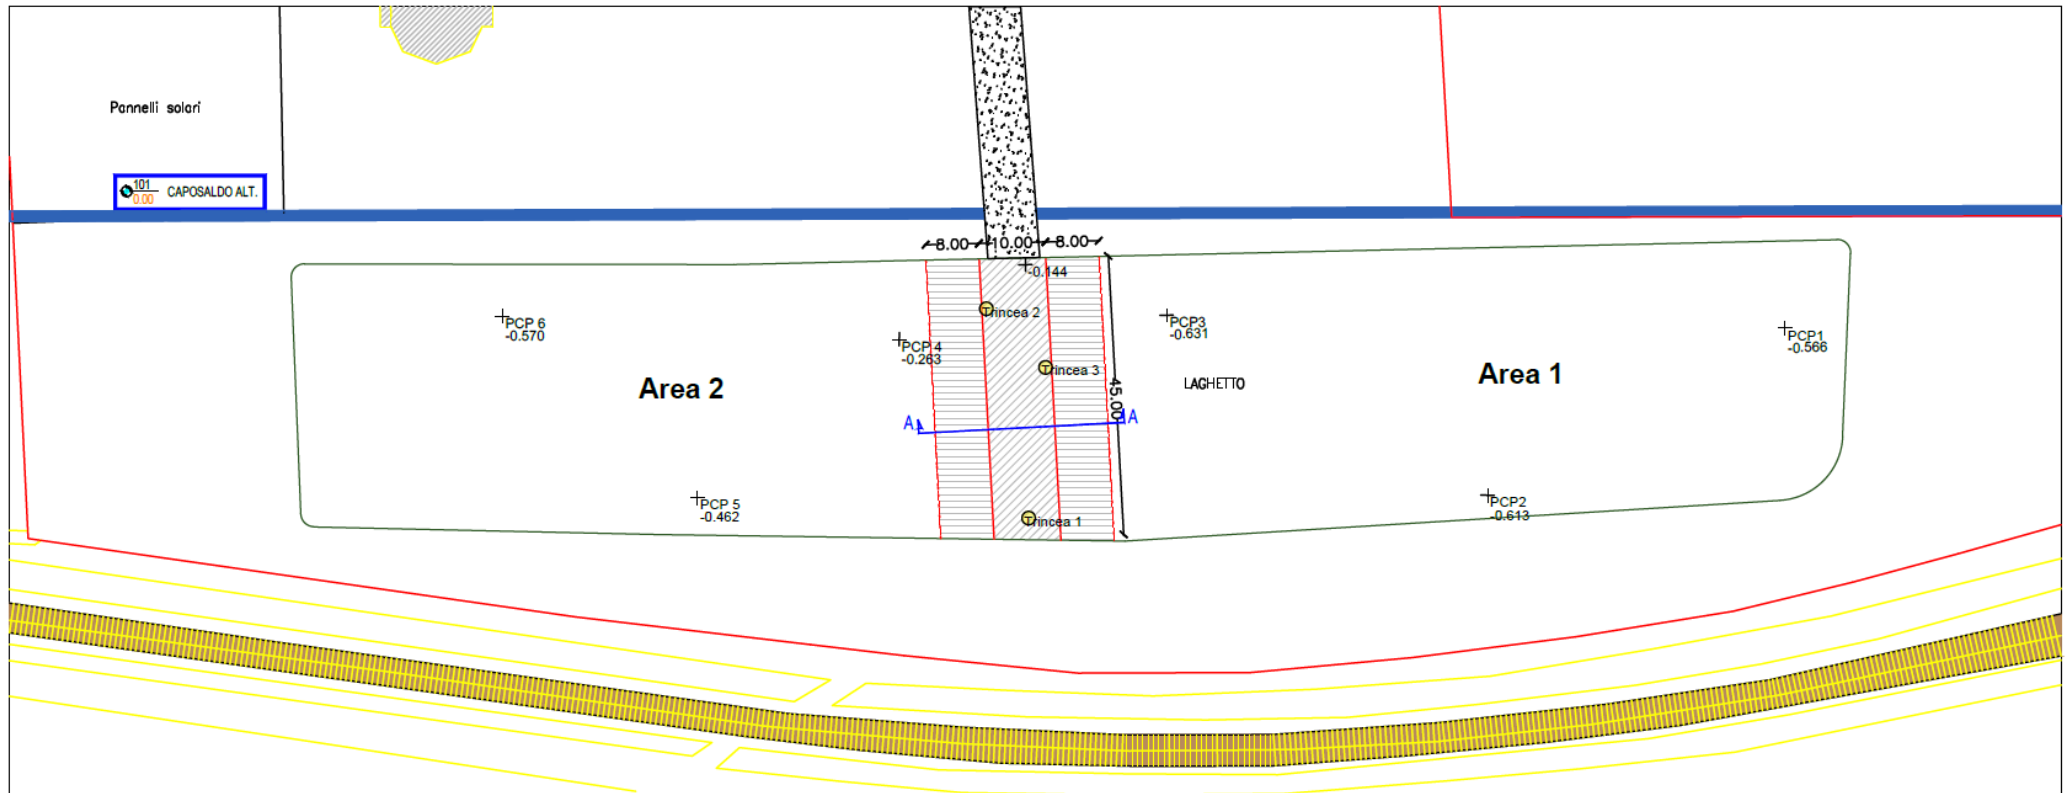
Estratto Tavola Prove Su Piastra - Planimetria dell'area con localizzazione delle due aree e dell'argine
